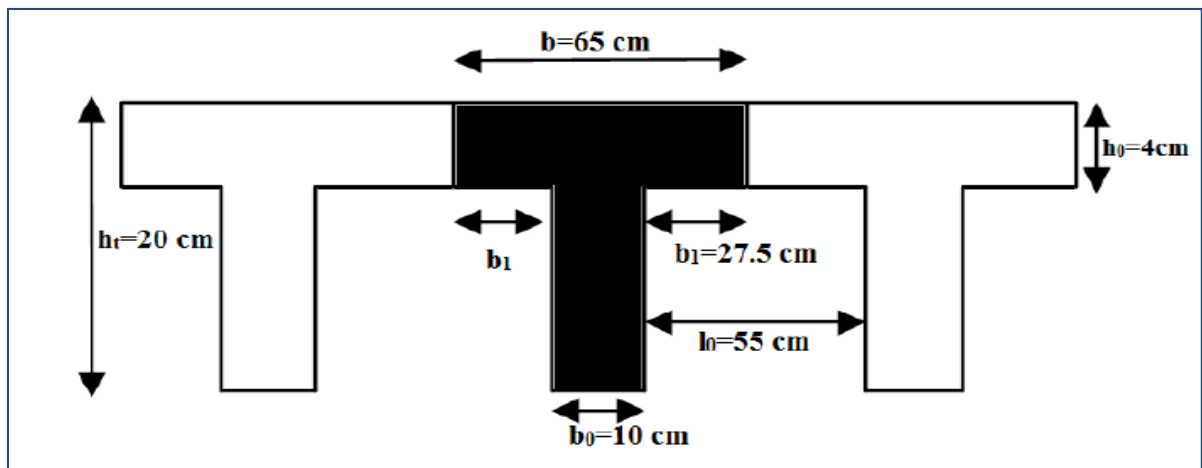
Coupe transversal d'un plancher à Corps creux
